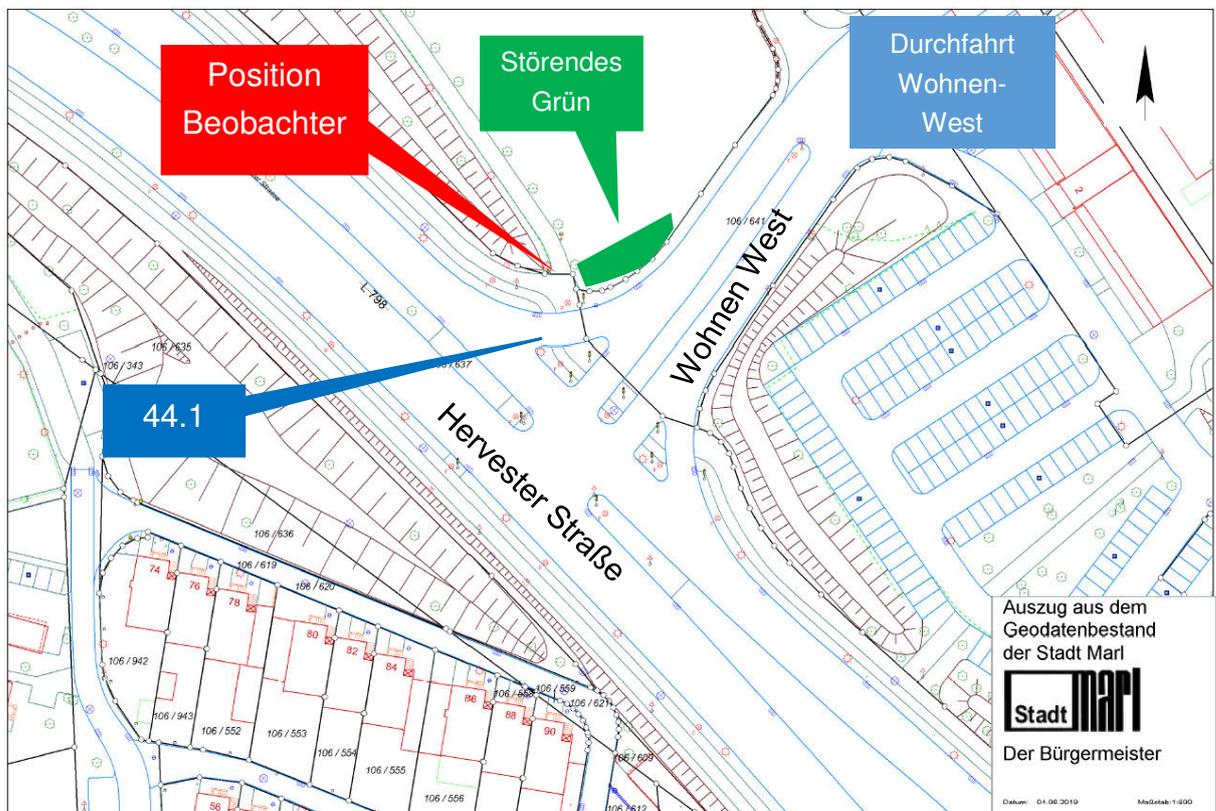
Lageplan 44.1 – Fahrtrichtung Finanzamt
